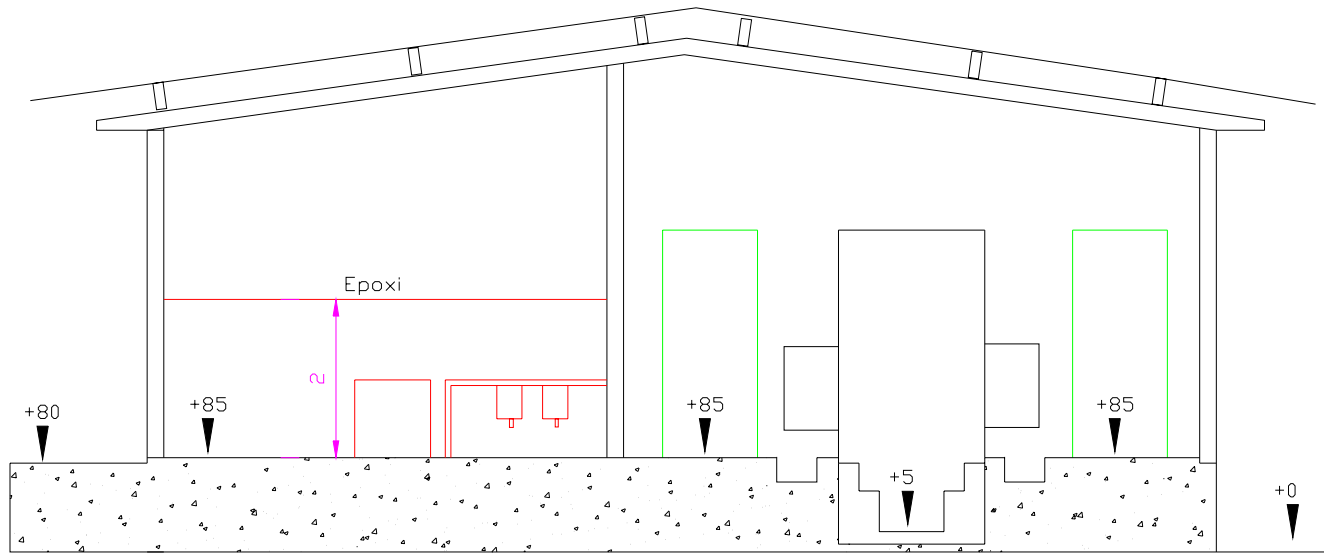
Detalhes da Construção da Sala de Ordenha Plana.
